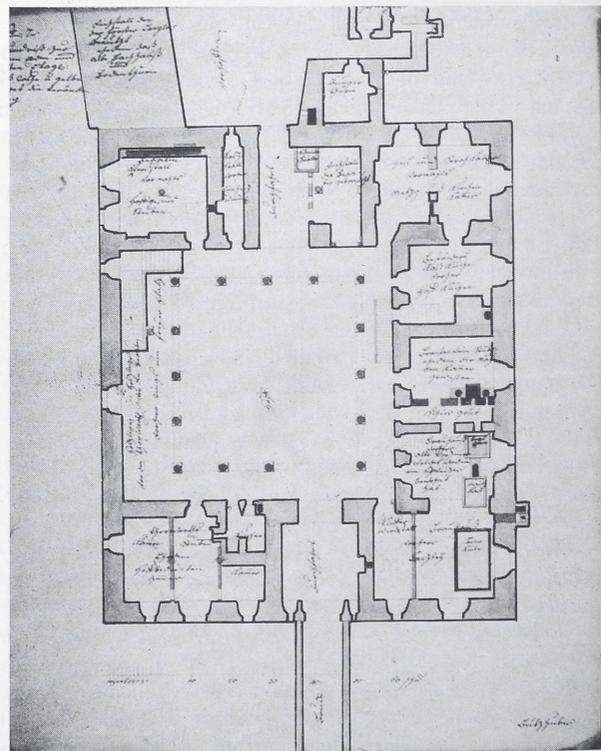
Grundriß Untergeschoß 1779 (Vorlage und Aufnahme HStA Stuttgart, A 402, Bü. 35. Alle Rechte vorbehalten).
